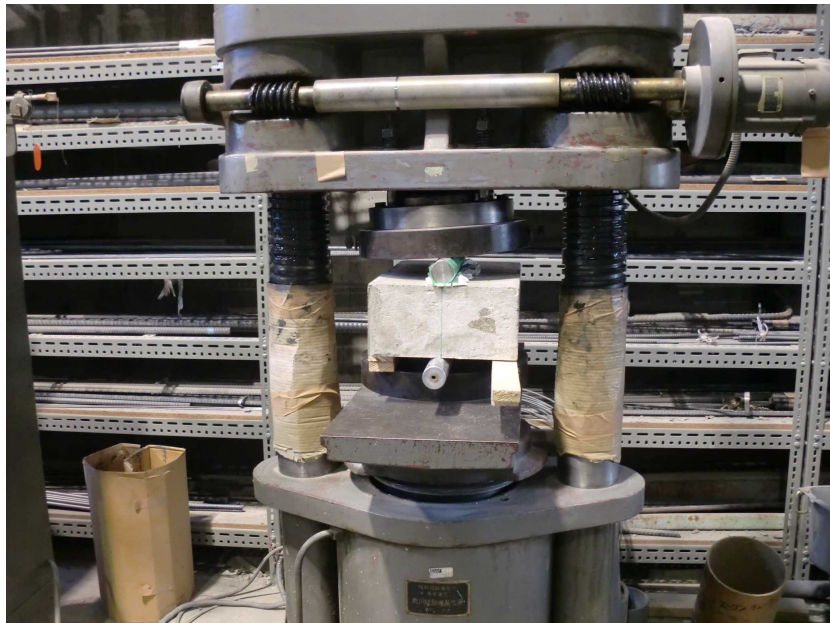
圧縮試験機による割裂ひび割れ導入状況
